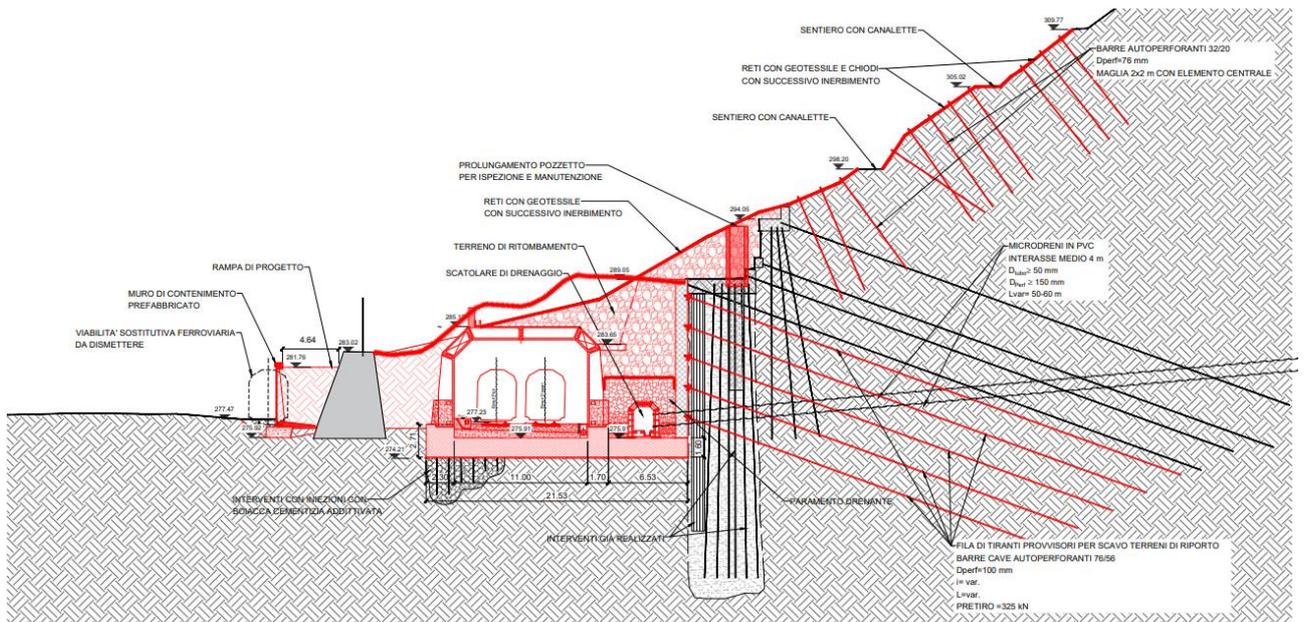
Situazione post operam – Sezione DD (vedere elaborati di progetto allegati)
